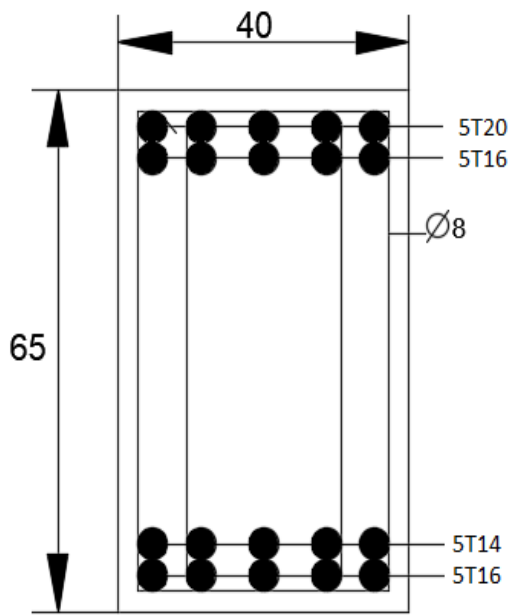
Dessin de ferrailage de sections des poutres le sens longitudinal de rive
